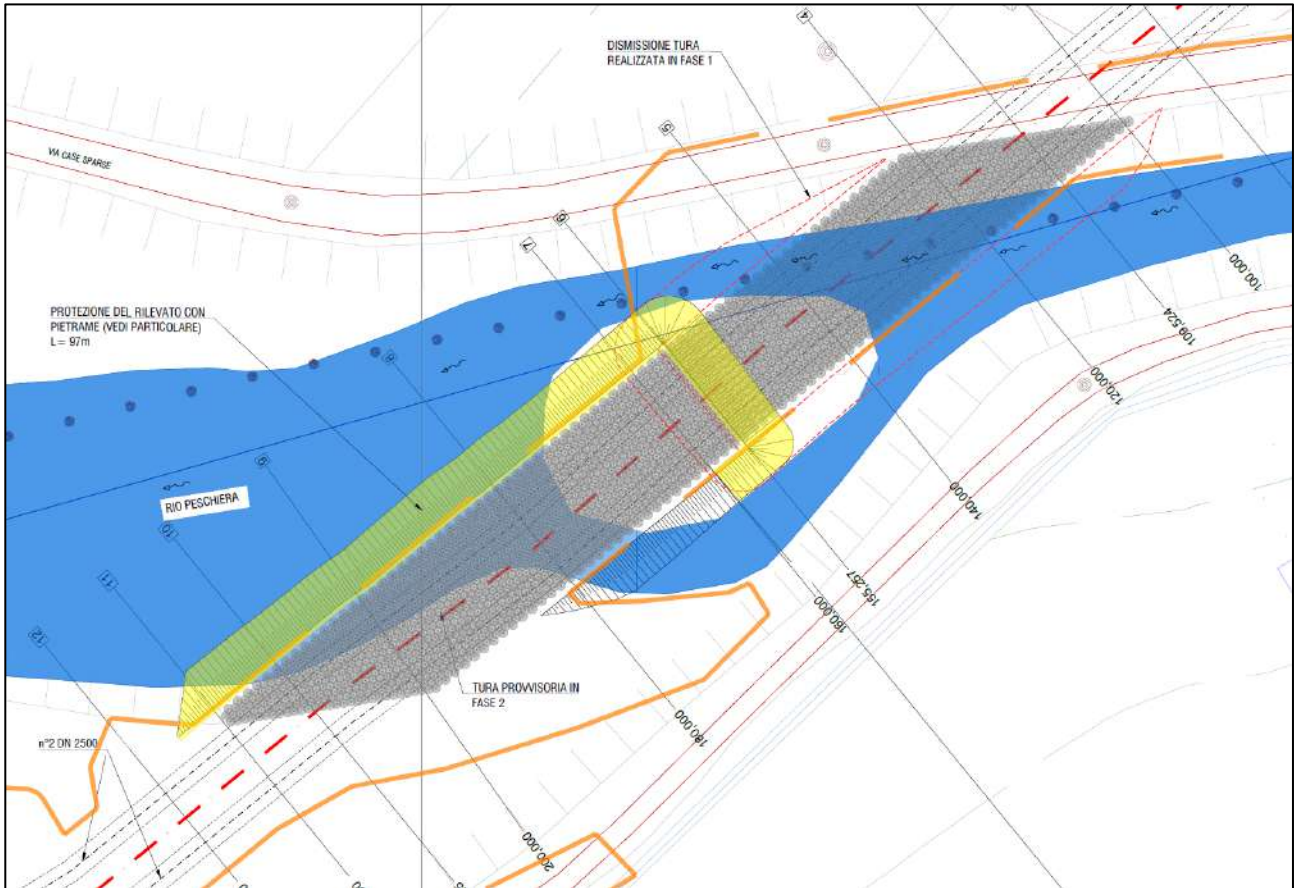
Planimetria delle opere di attraversamento lungo la Piana di San Vittorino
